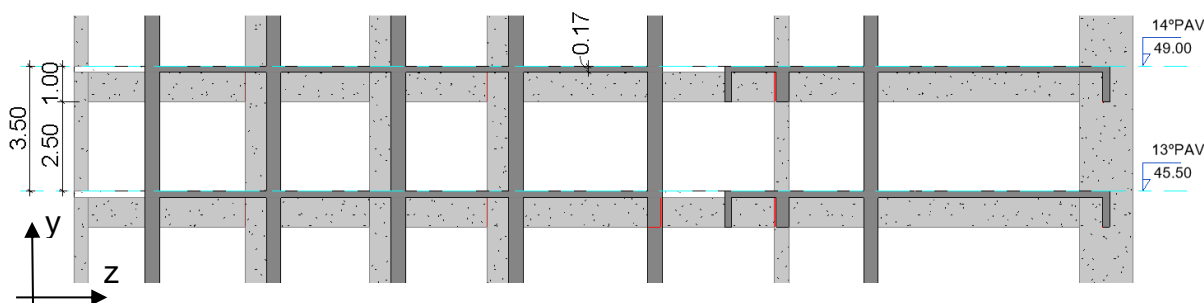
Corte Pavimento Tipo Edifício de 140 m.
